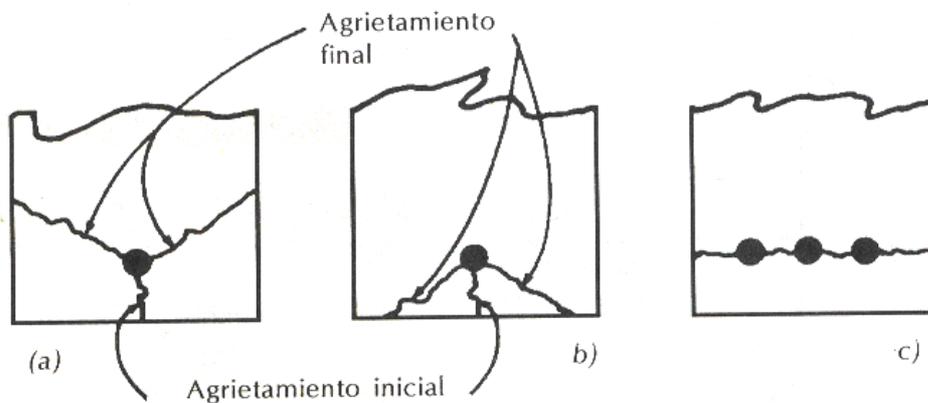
Diferentes configuraciones del agrietamiento longitudinal.
